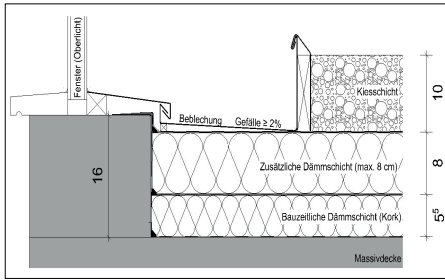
Möglicher Dachaufbau bei konstruktiv begrenzter Höhe
